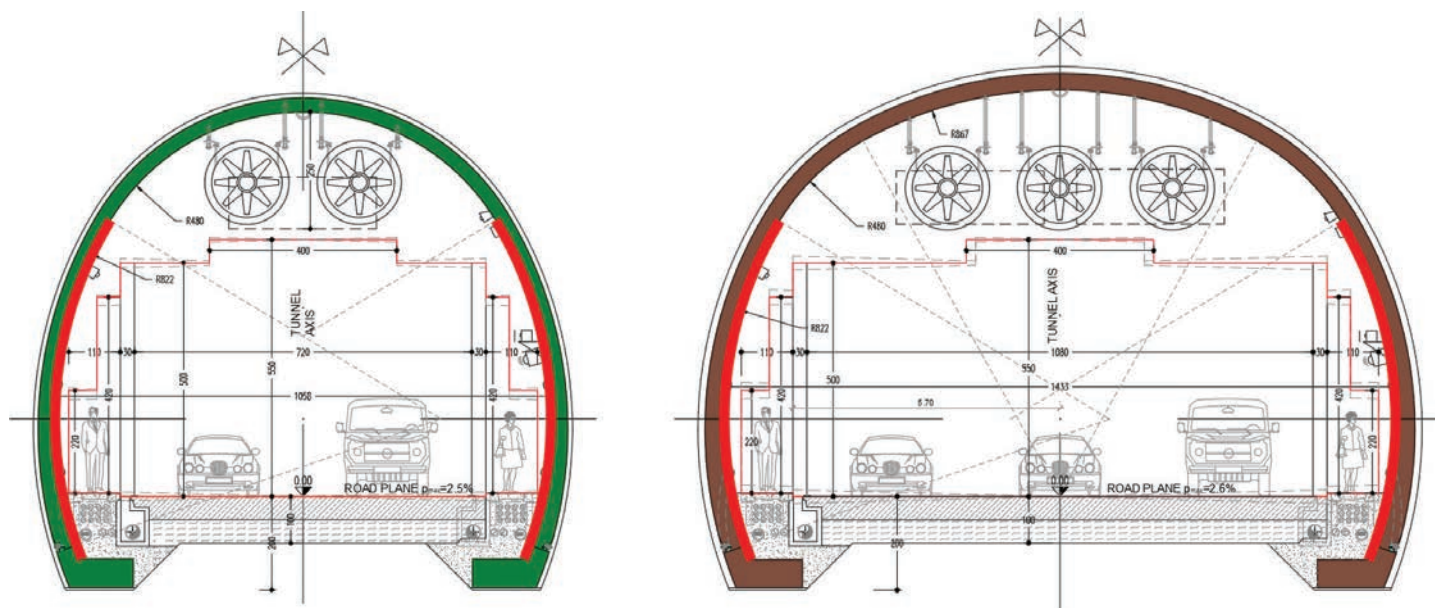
a) Sezione tipo 2L – 10 m; b) Sezione tipo 3L – 13.6 m.
